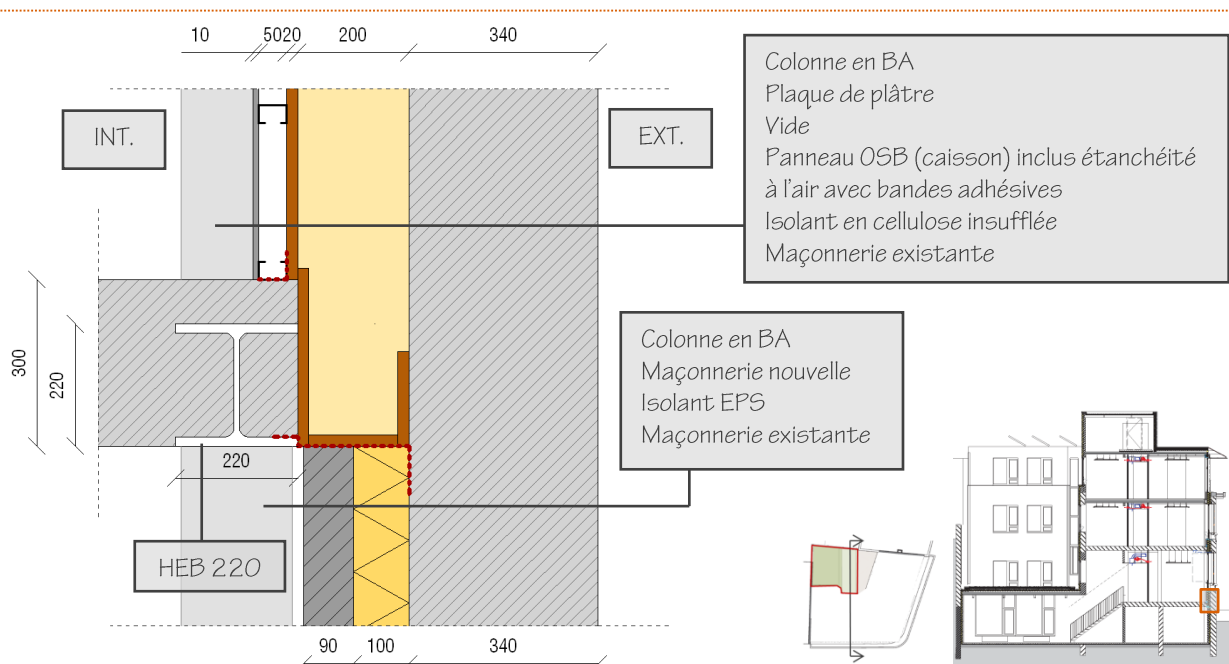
Détail de l'isolation par l'intérieur de la façade avant au droit du plancher du rez-de-chaussée, mesures en [mm]
